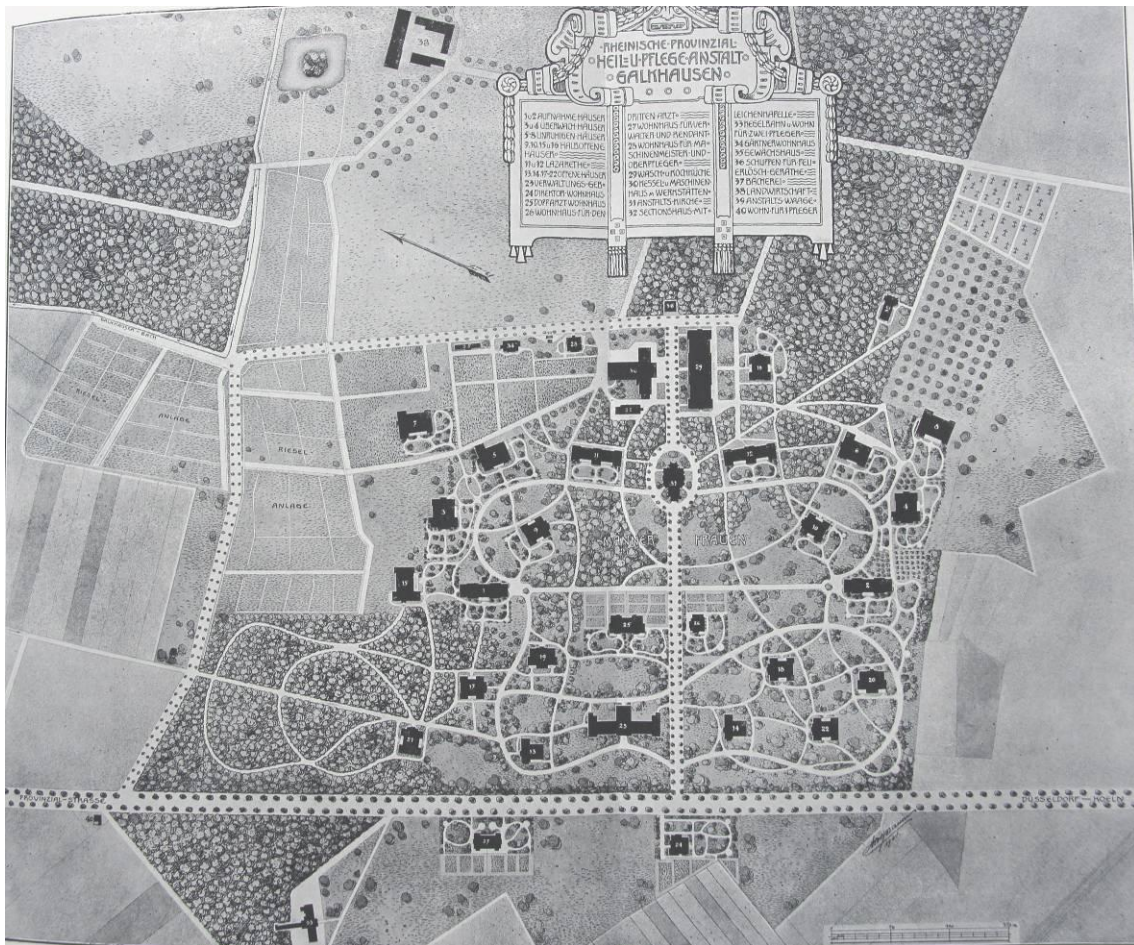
Lageplan der Irrenanstalt Galkhausen
